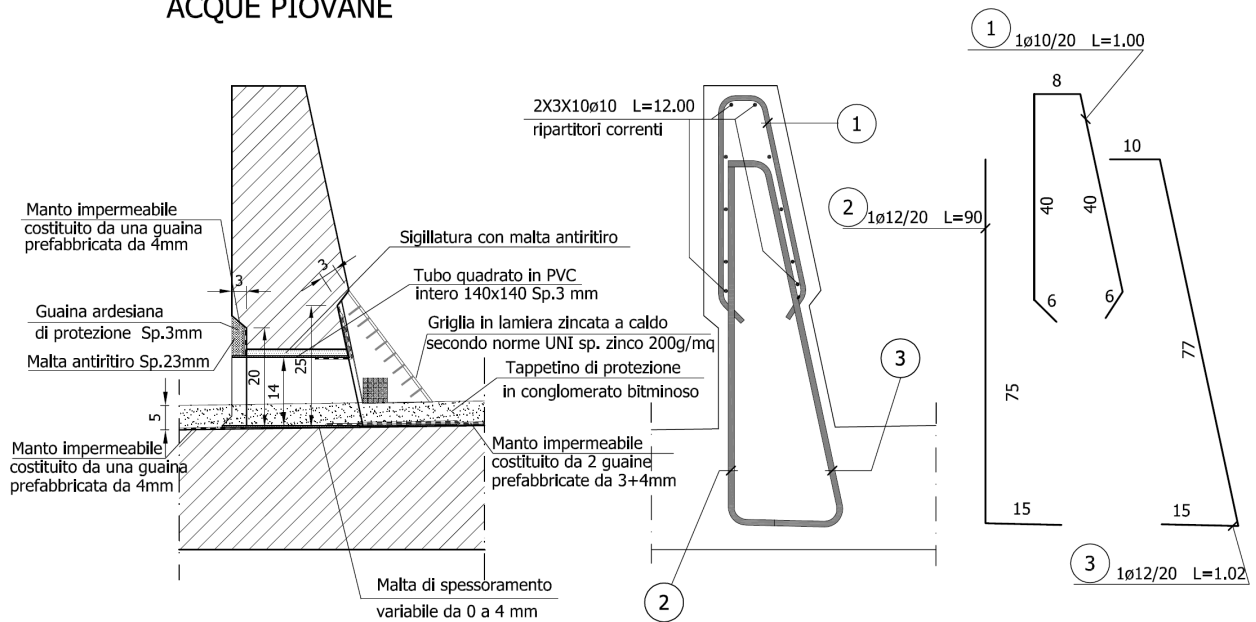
Muretto parballast e foro di smaltimento delle acque
